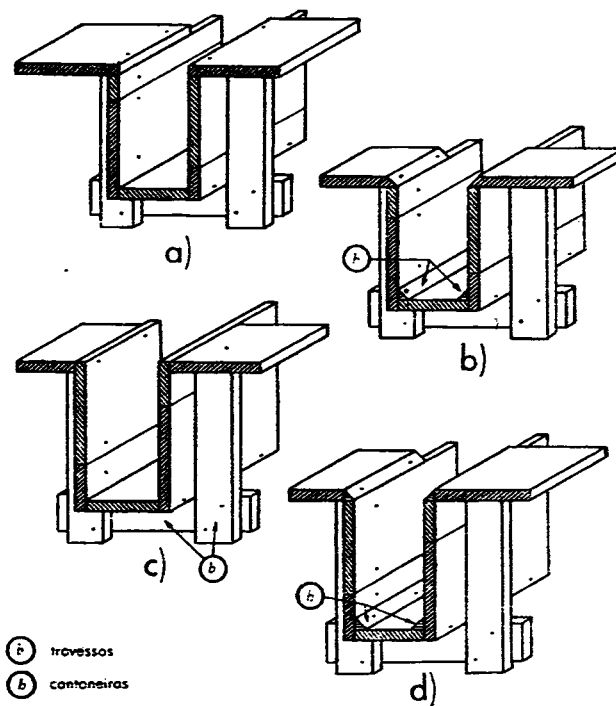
Detalhes de cantoneiras e travessas (Fonte: ABCP, 1943).
